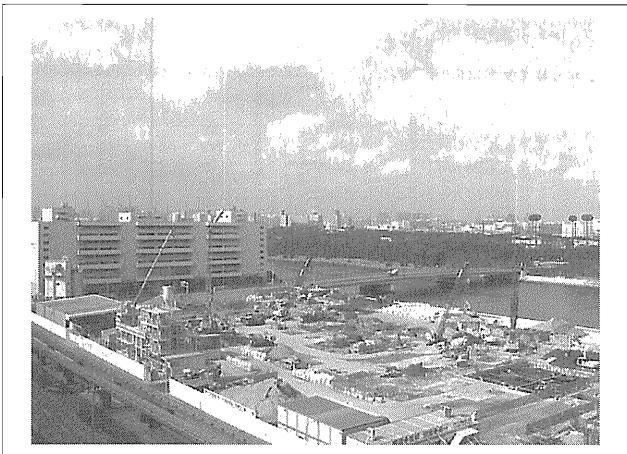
基礎工事とプラントの状況 (東京団地倉庫(株)平和島倉庫A-1棟)
